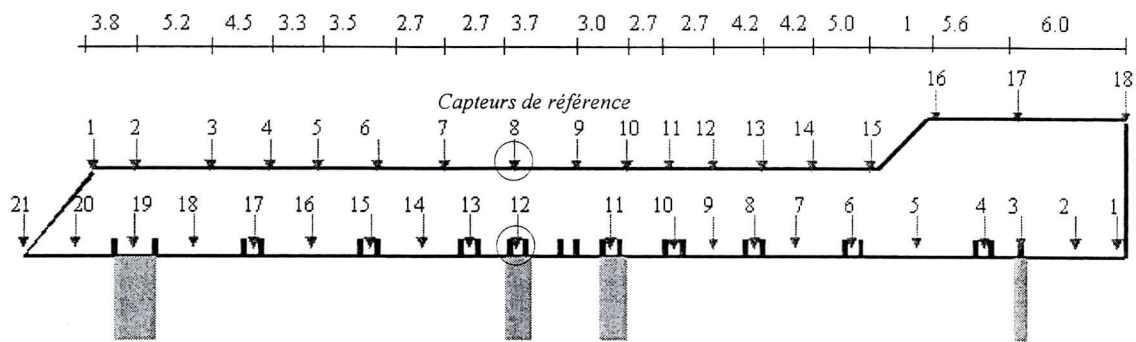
Schéma d'instrumentation sur la poutre caisson C43.
